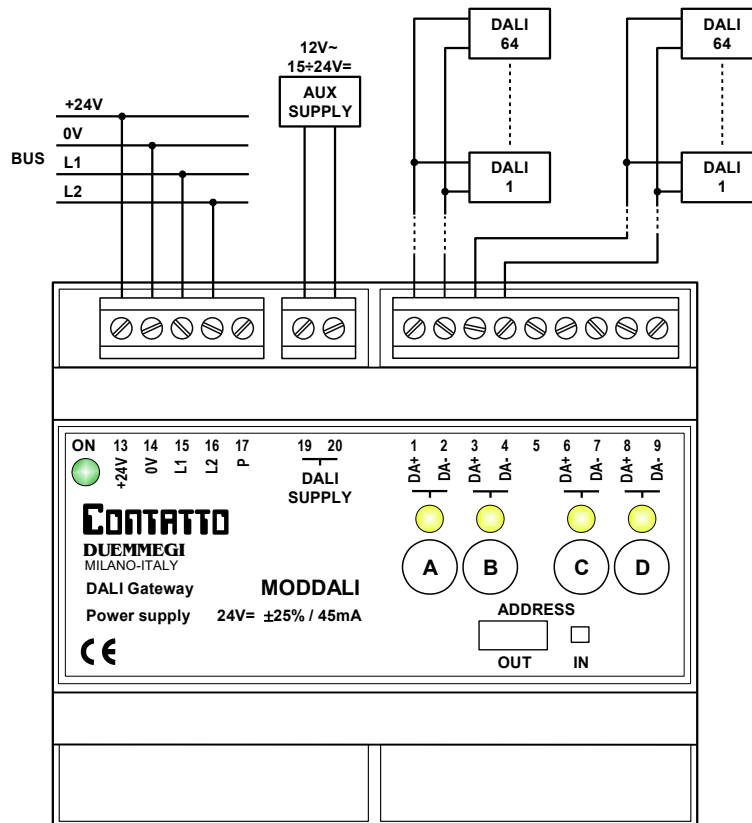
Schema di collegamento versione speciale 2 linee 64 ballast
